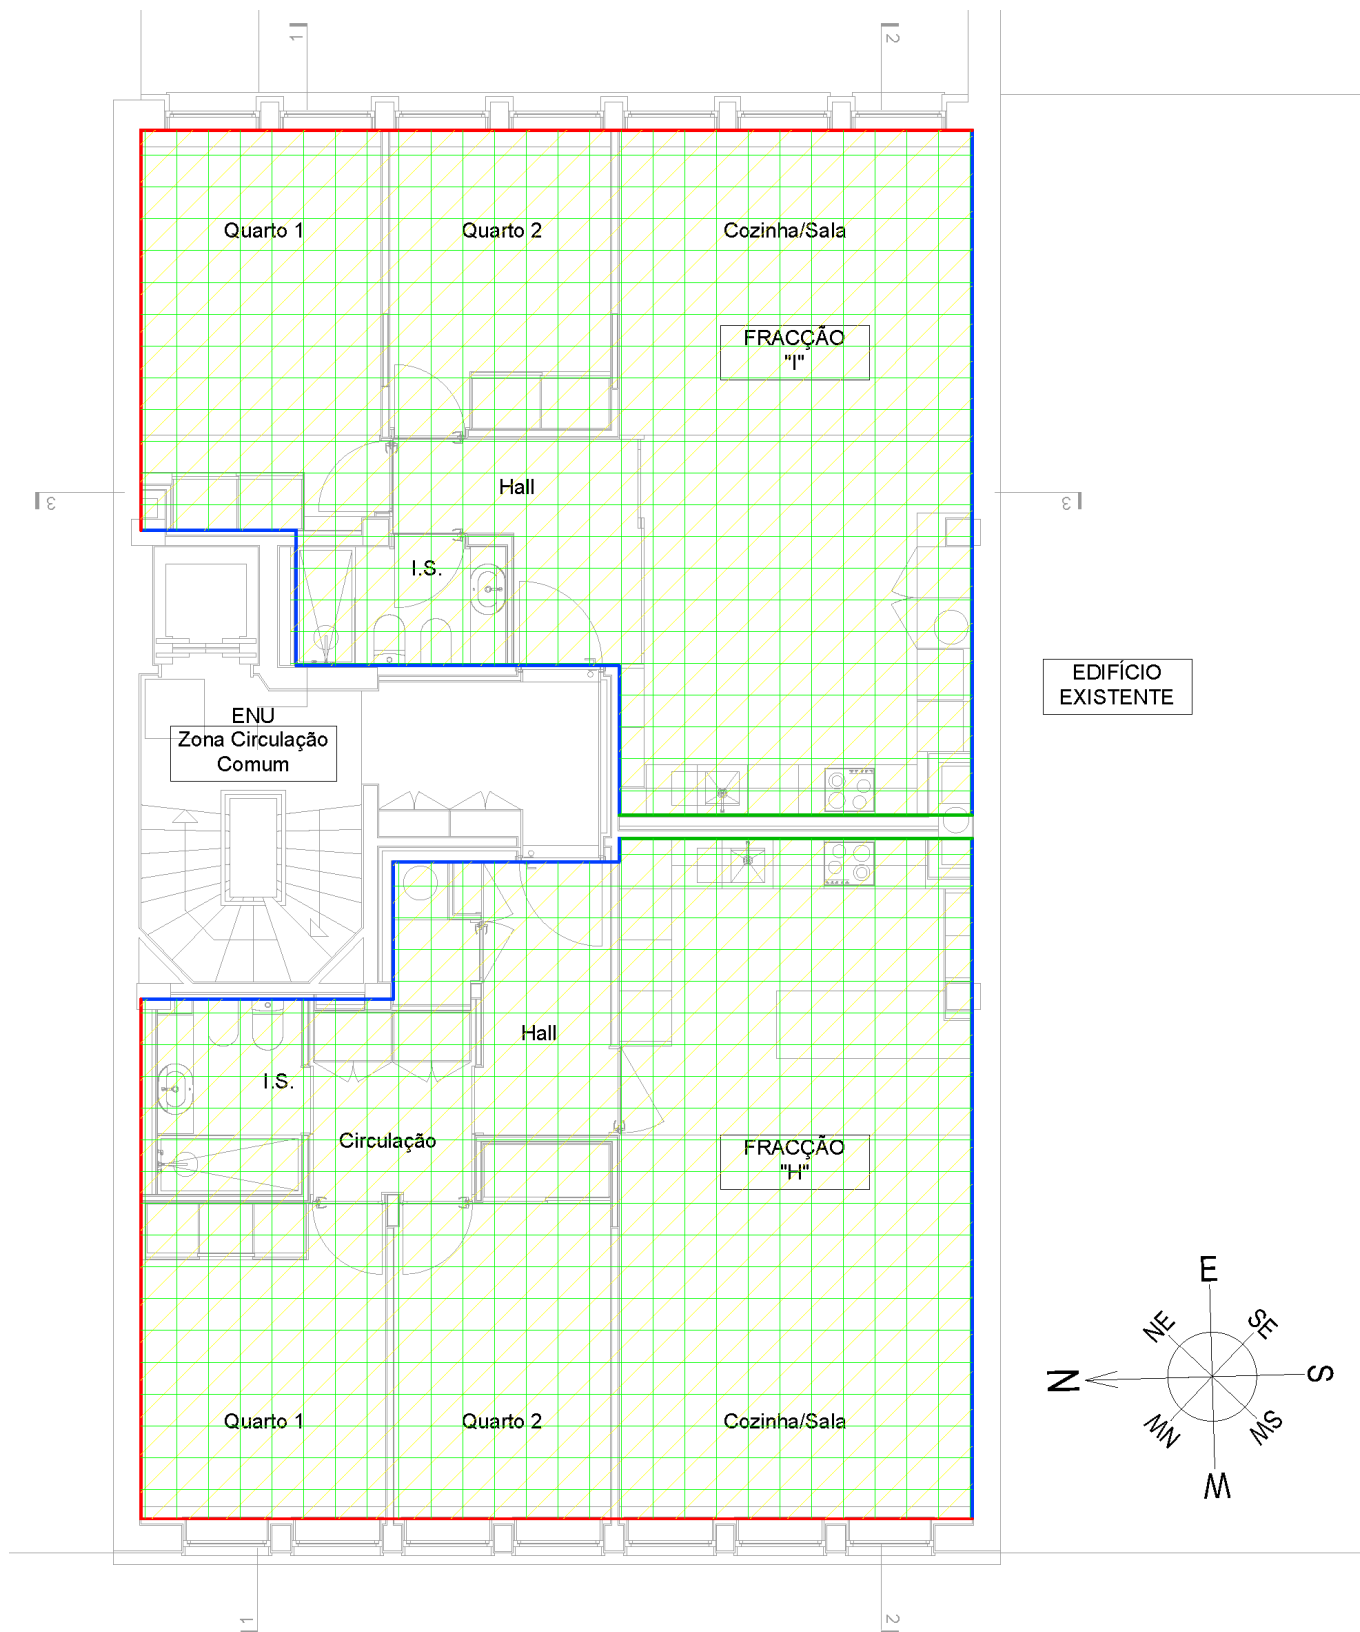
Envolvente das fracções (Planta do Piso 4)
